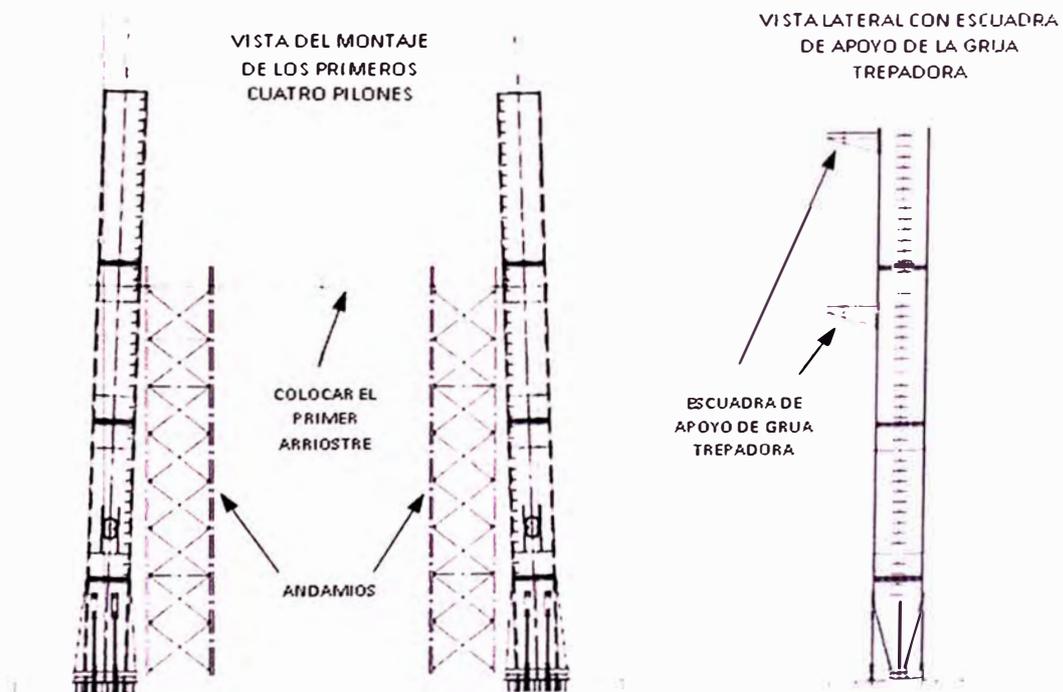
MONTAJE DE LOS PRIMEROS CUATRO PILONES
